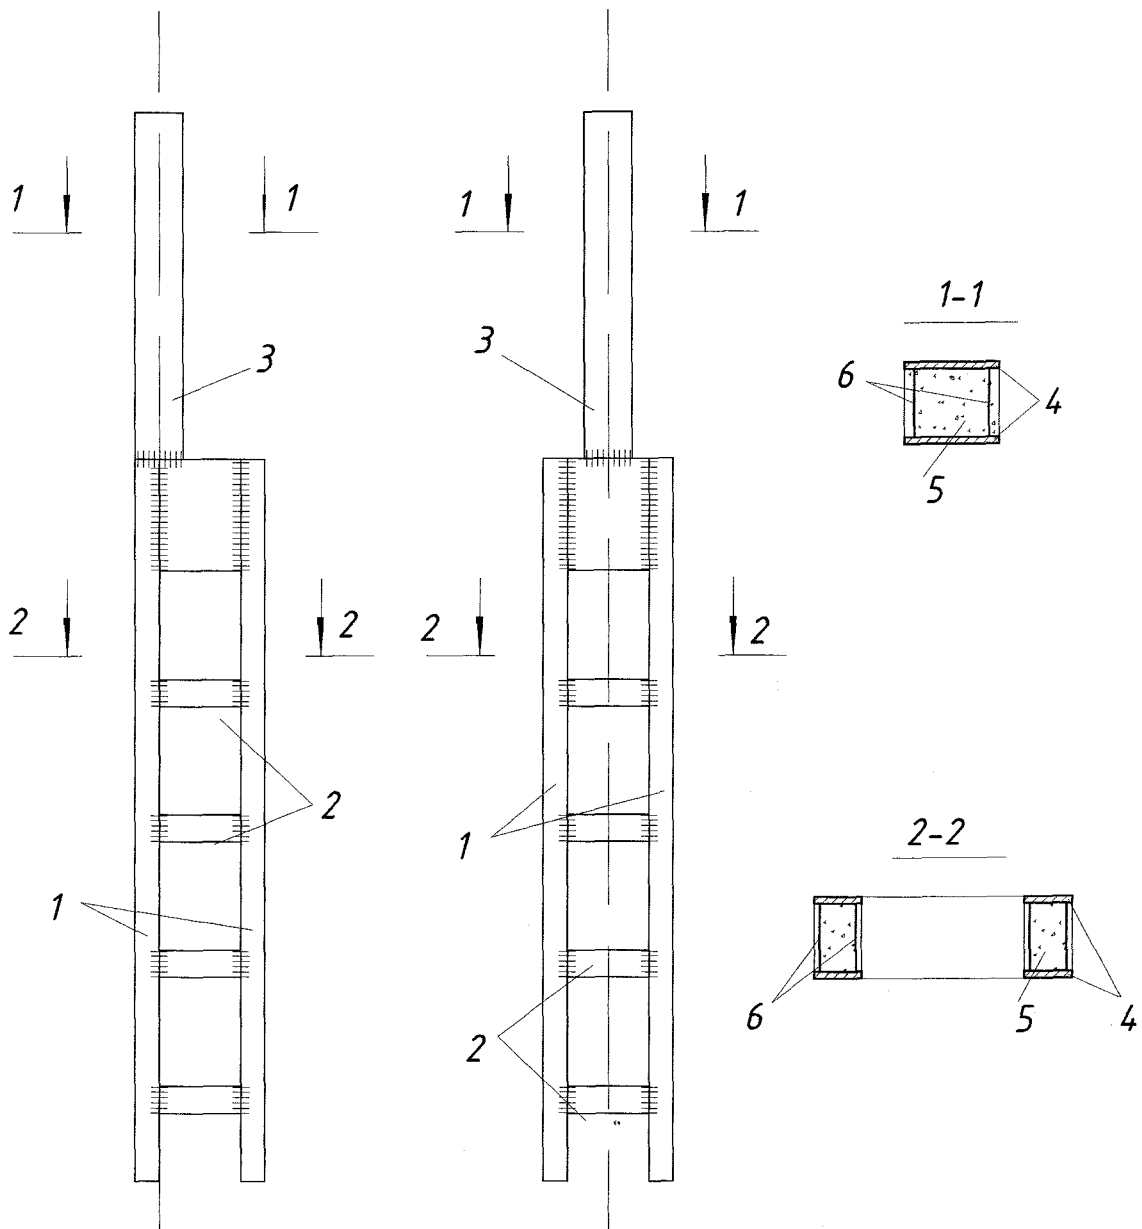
Наскрізна залізобетонна колона із зовнішнім листовим армуванням:
